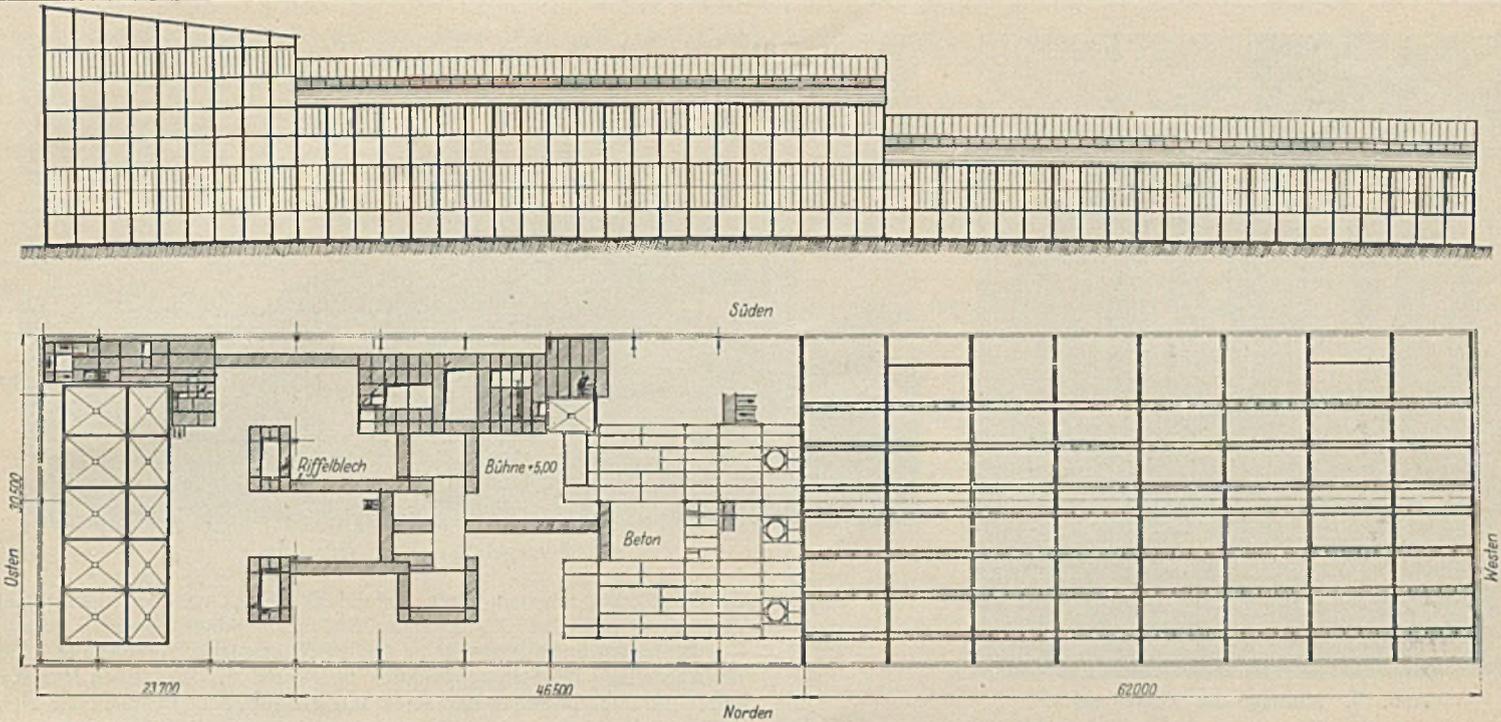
Sintererei, Schmelzanlage und Gießerei; Grundriß und Ansicht.
